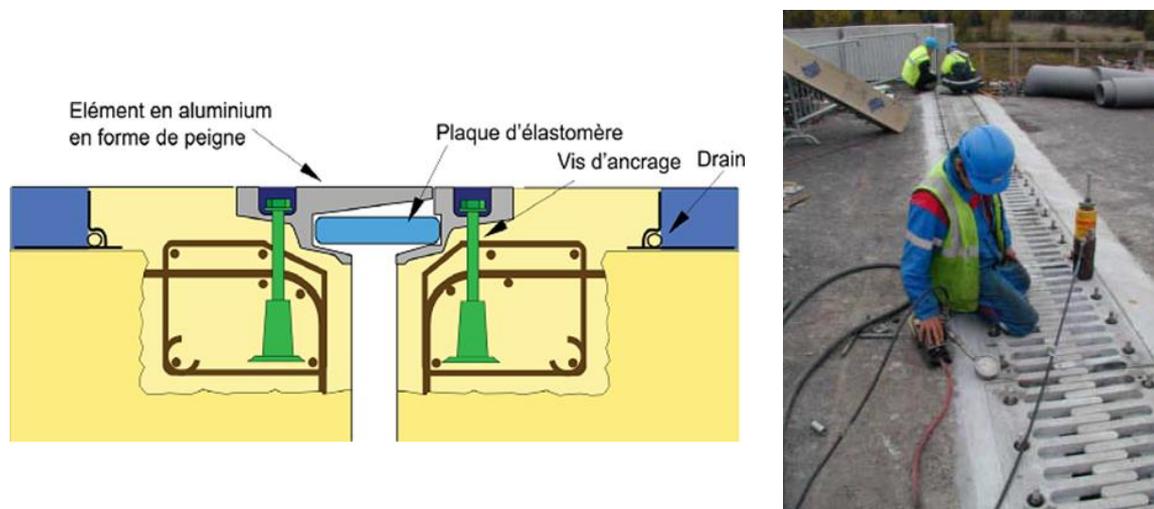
Détail d'un joint de chaussée type cantilever et serrage des vis d'ancrage
